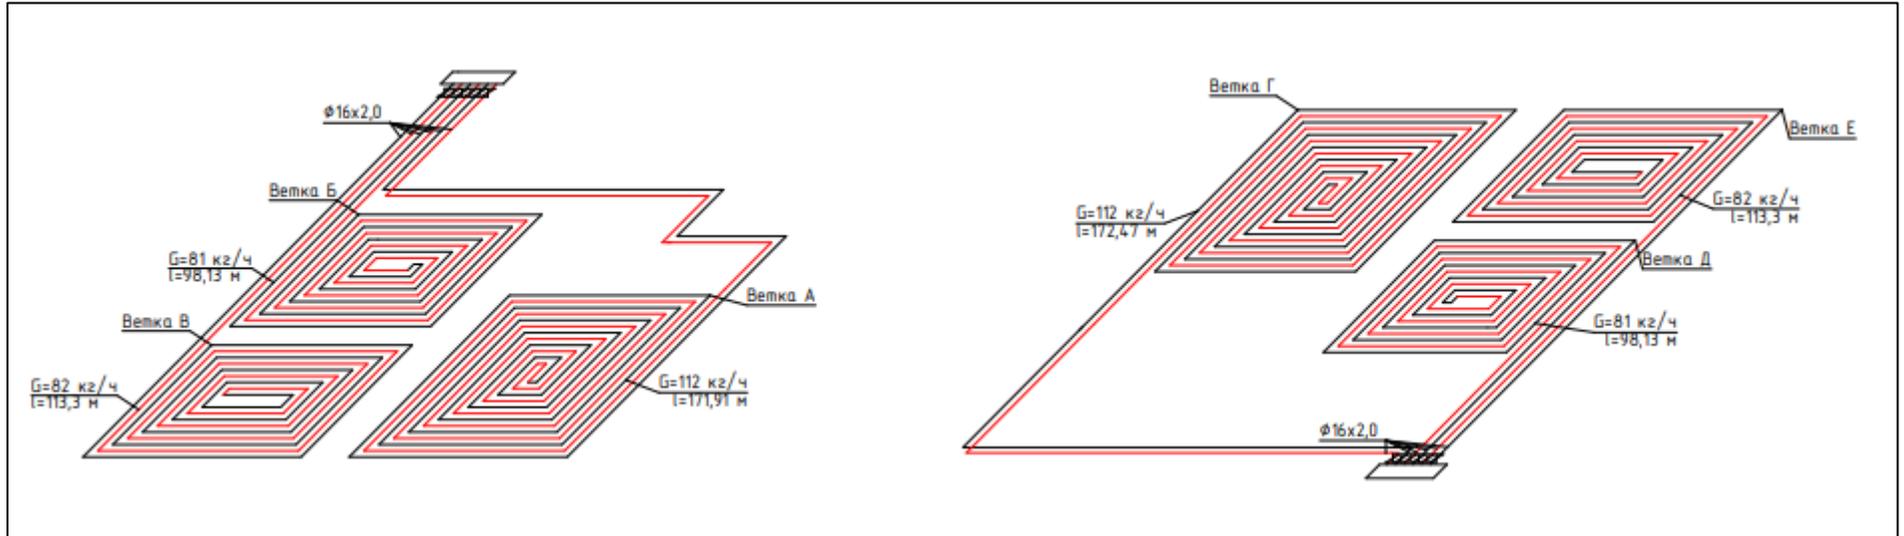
Расчетная схема напольного отопления блоков №1 и №2
